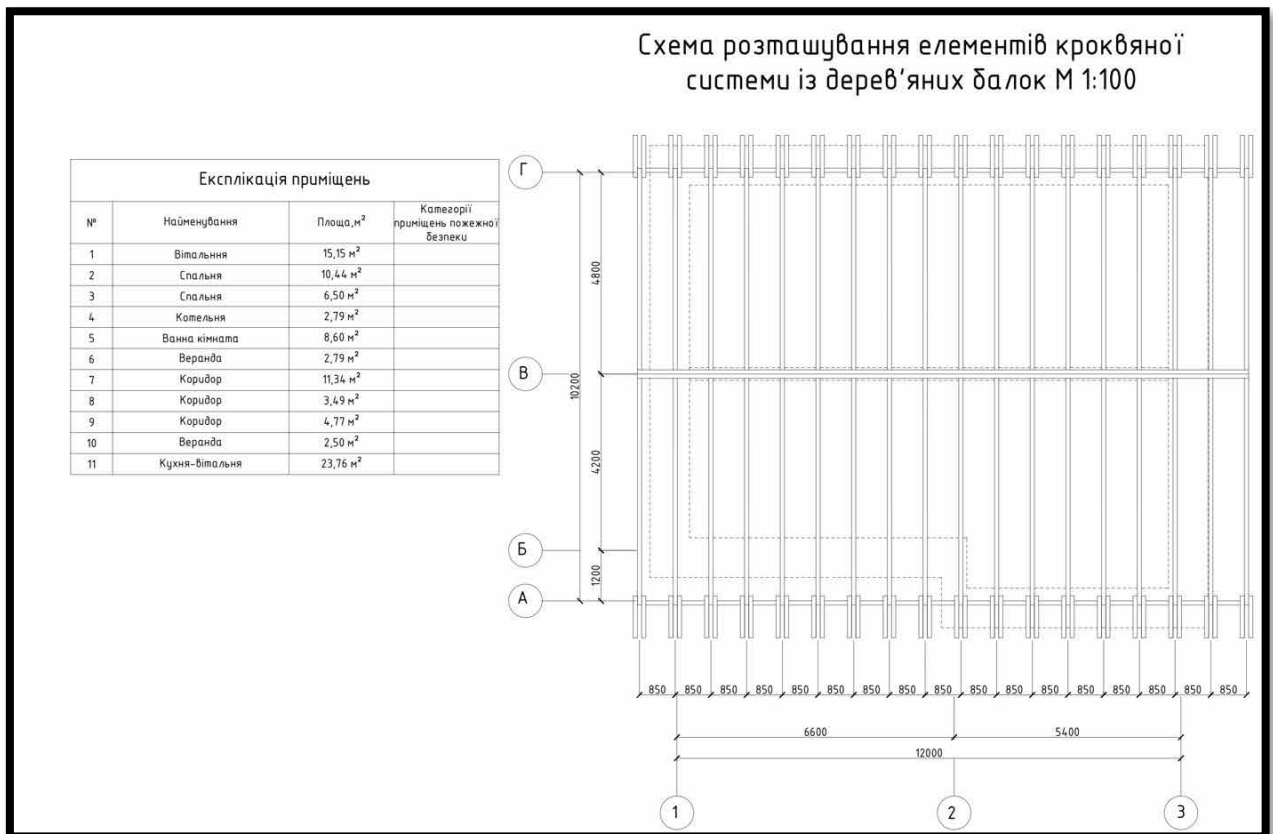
Схема розташування елементів кровляної системи із дерев'яних балок
